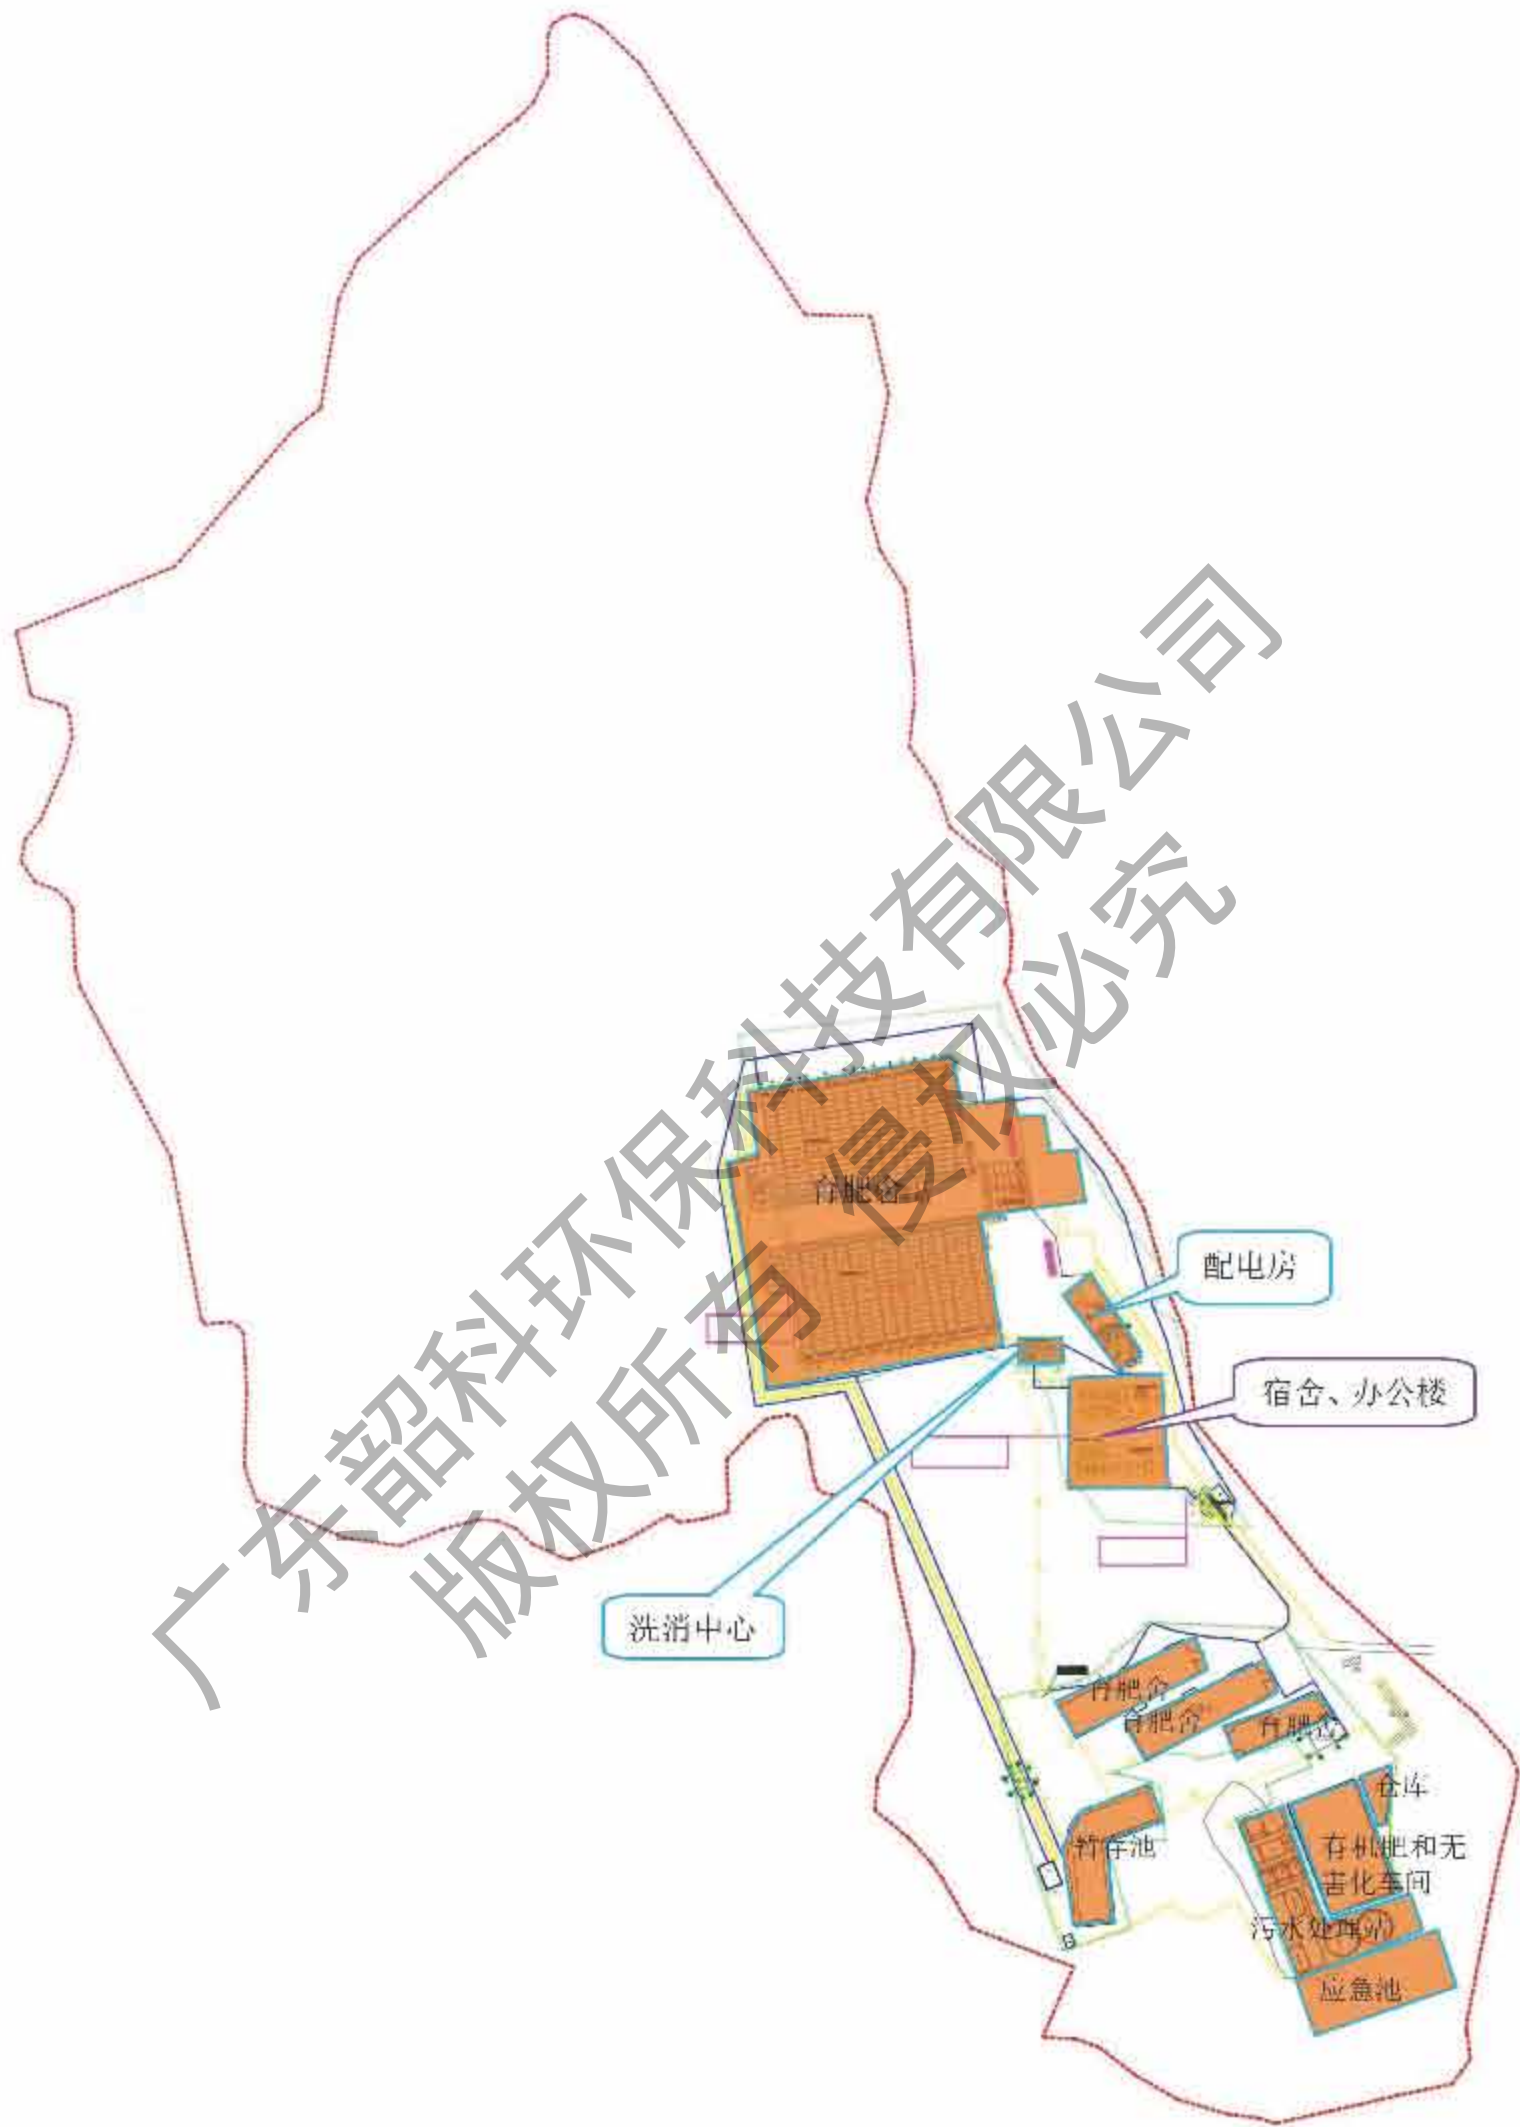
(a) 项目平面布置图 (场内平面布置)
